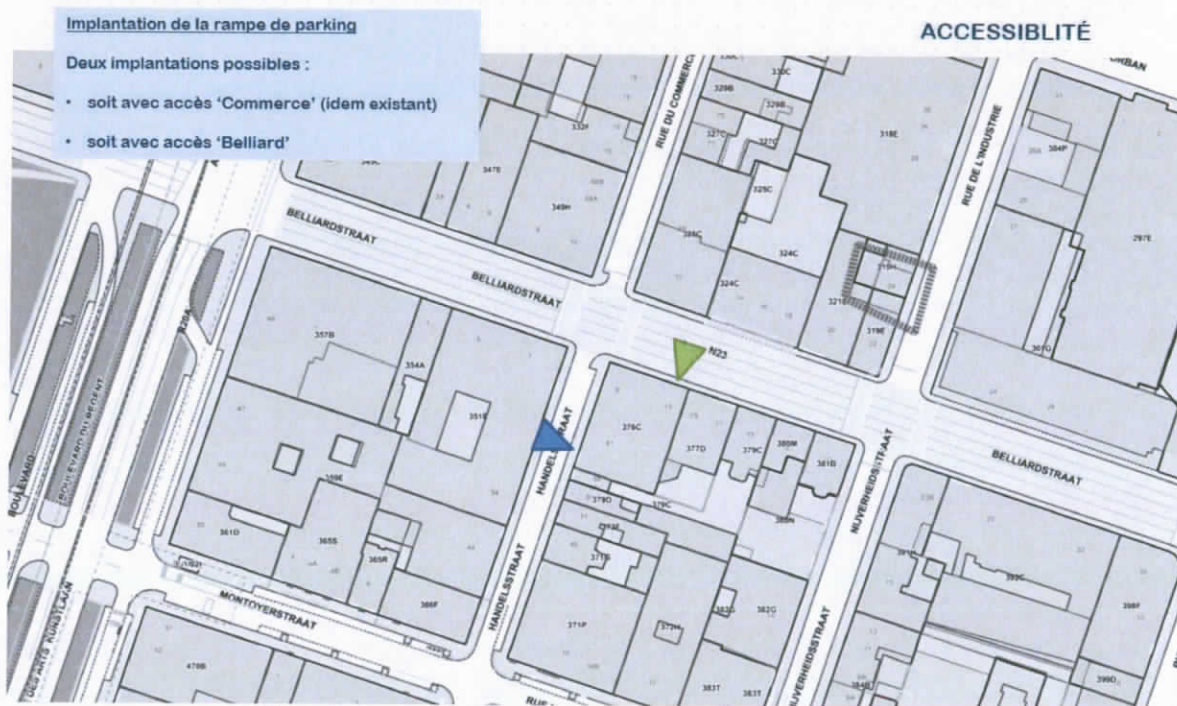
Propositions d'accès au parking (Source : A&B 2016)
